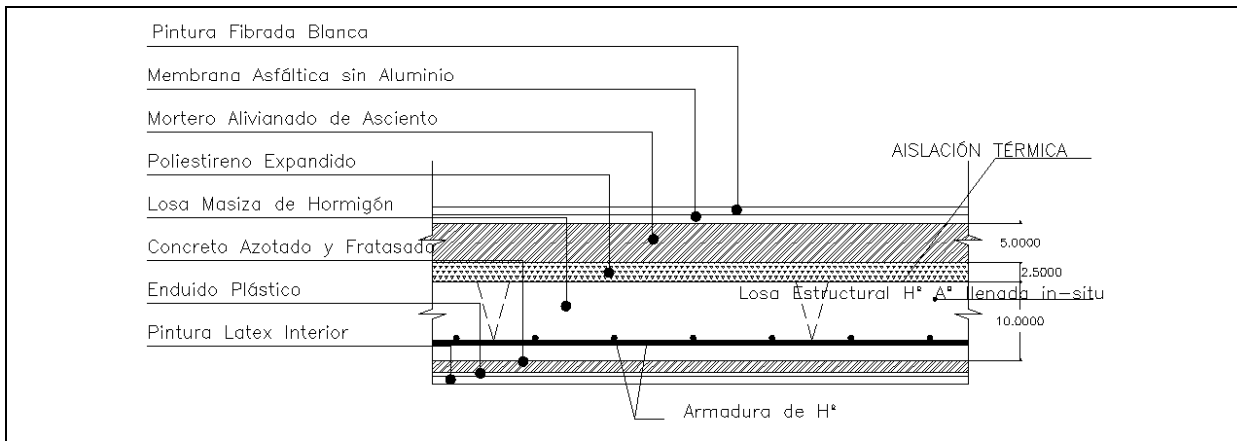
Detalle Cubierta Pesada de losa de H° A° (Conservativa). Aislación de Poliestireno Expandido.
